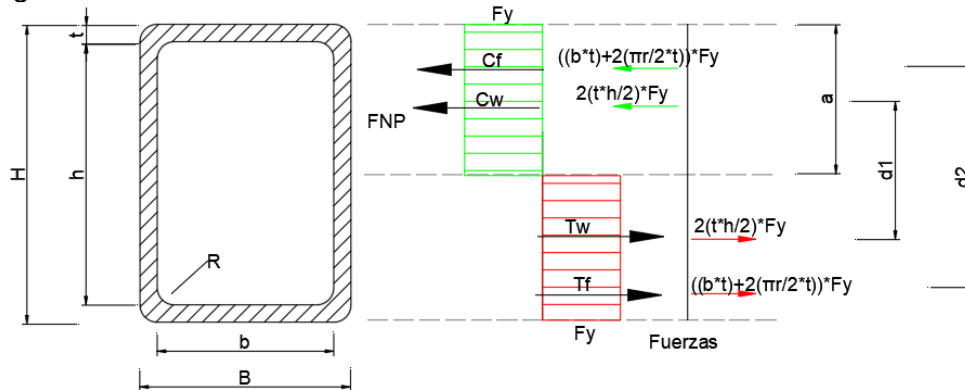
Distribución de tensiones plásticas de la viga de acero.
